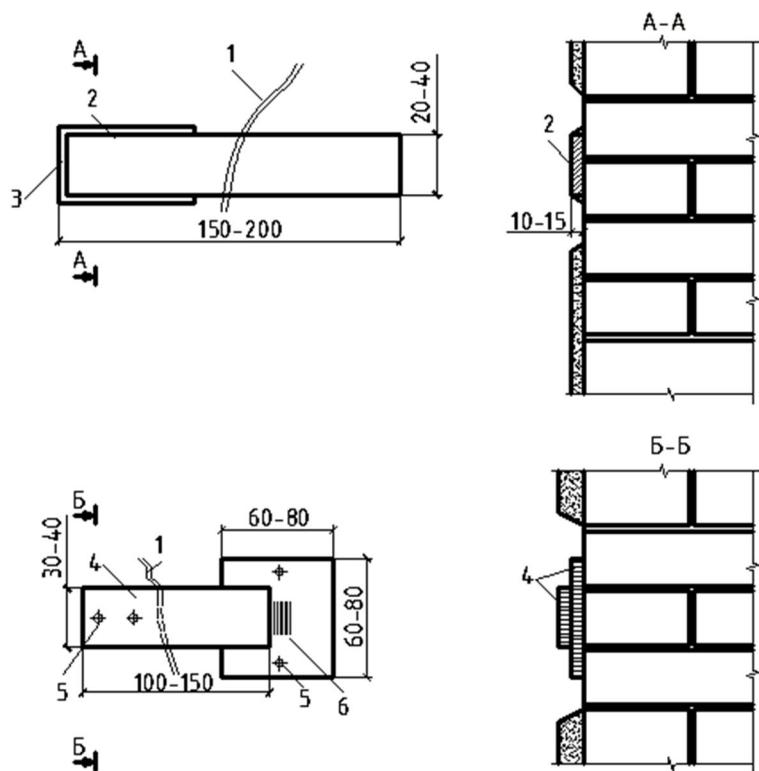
Маяки для наблюдения за раскрытием трещин в стенах и перегородках:
